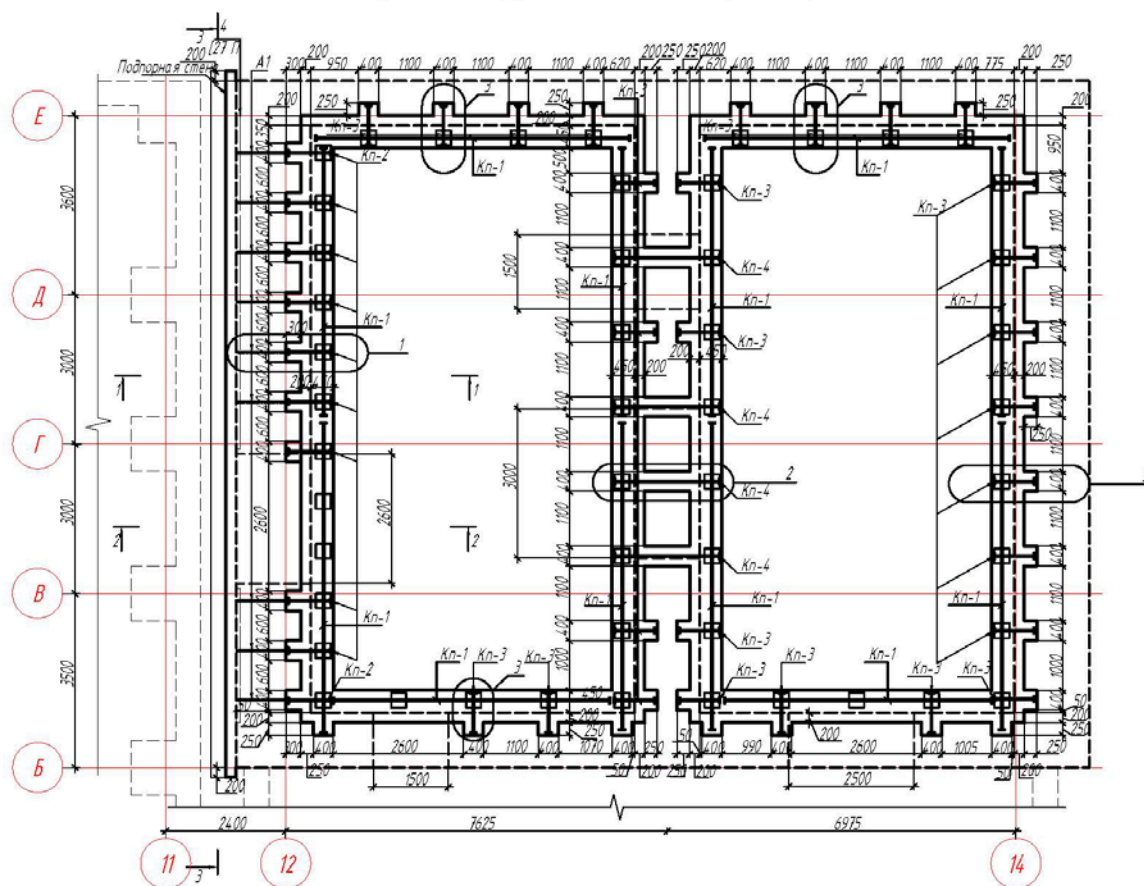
Схема усиления фундамента (ростверк)
